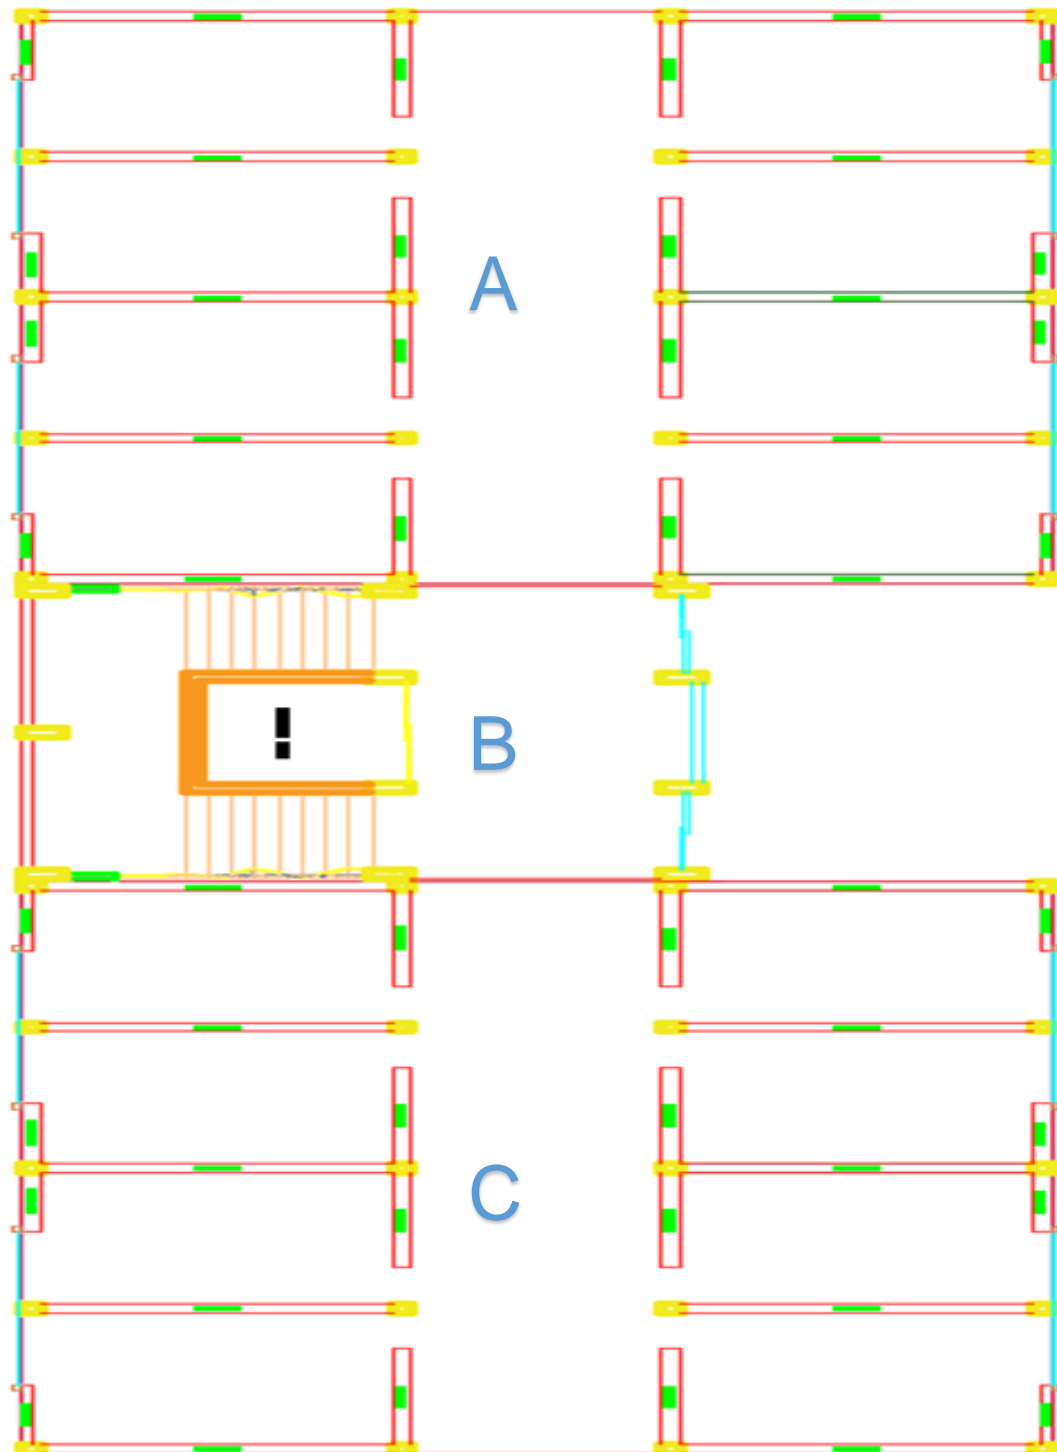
Estructuración en el sistema de albañilería confinada
